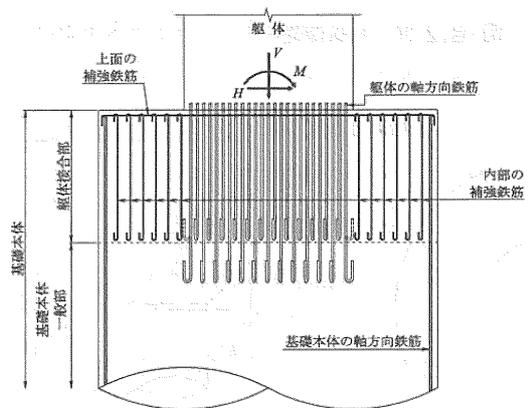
柱状体深礎基礎の躯体接合部の構造例
